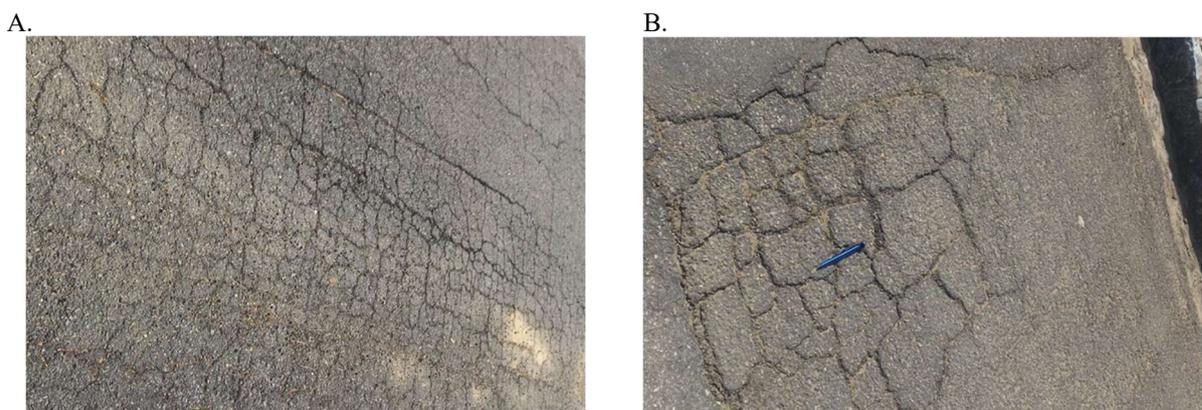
Trincas transversais presentes no pavimento do Campus
